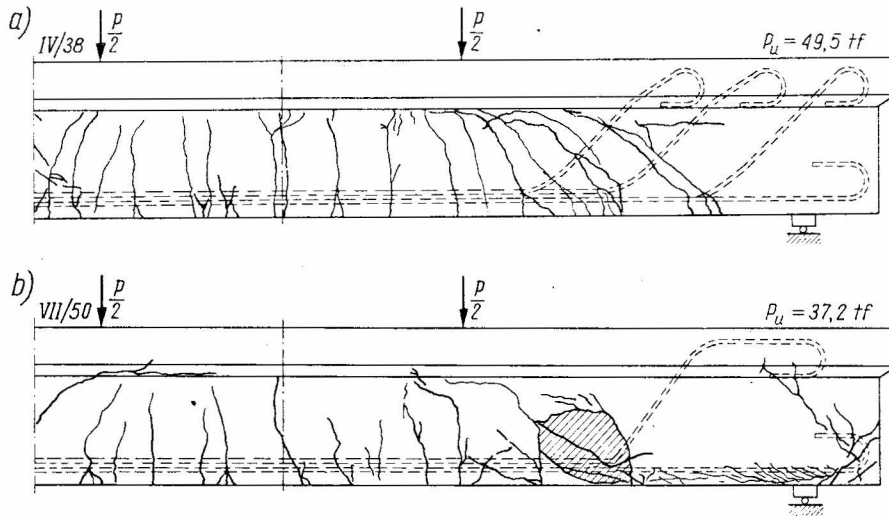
Fissuration des poutres dans les essais [3] : a) poutre IV/38 avec des barres relevées à grand rayon de courbure, b) poutre VII/50 avec des angles vifs des barres
